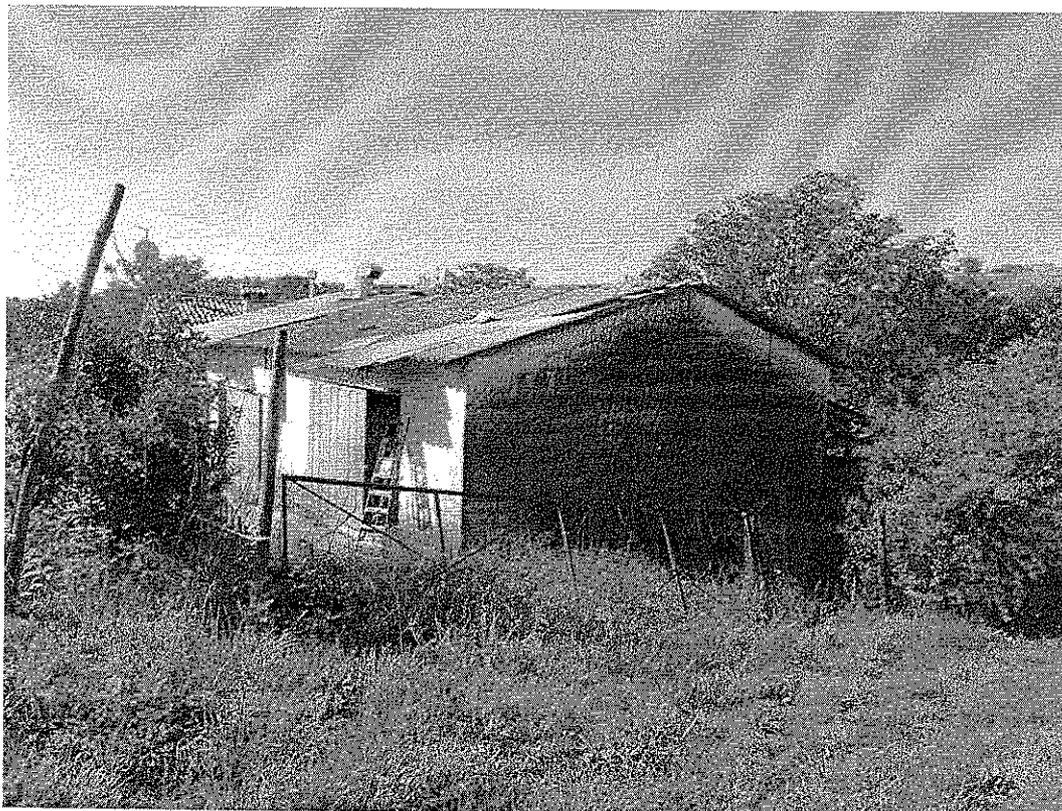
prospetto e confine Nord – magazzino principale con tetto in eternit
